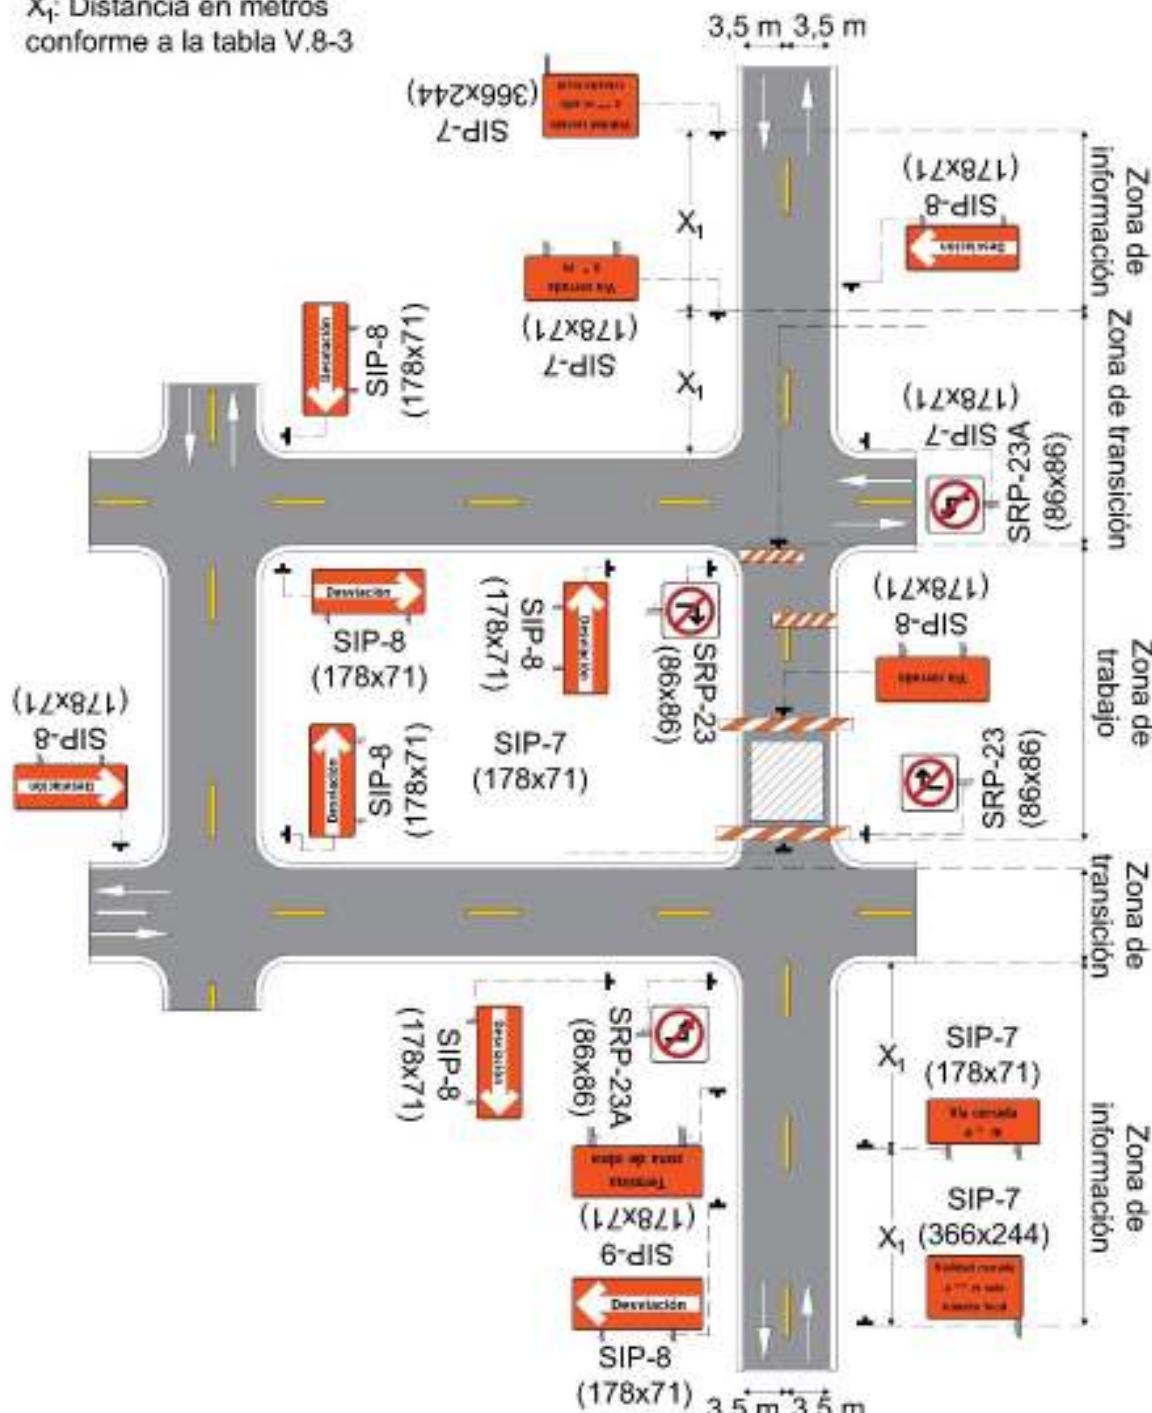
Cierre de carril en calle con desvío (Vía con ancho de arroyo vial menor a 9 m)
